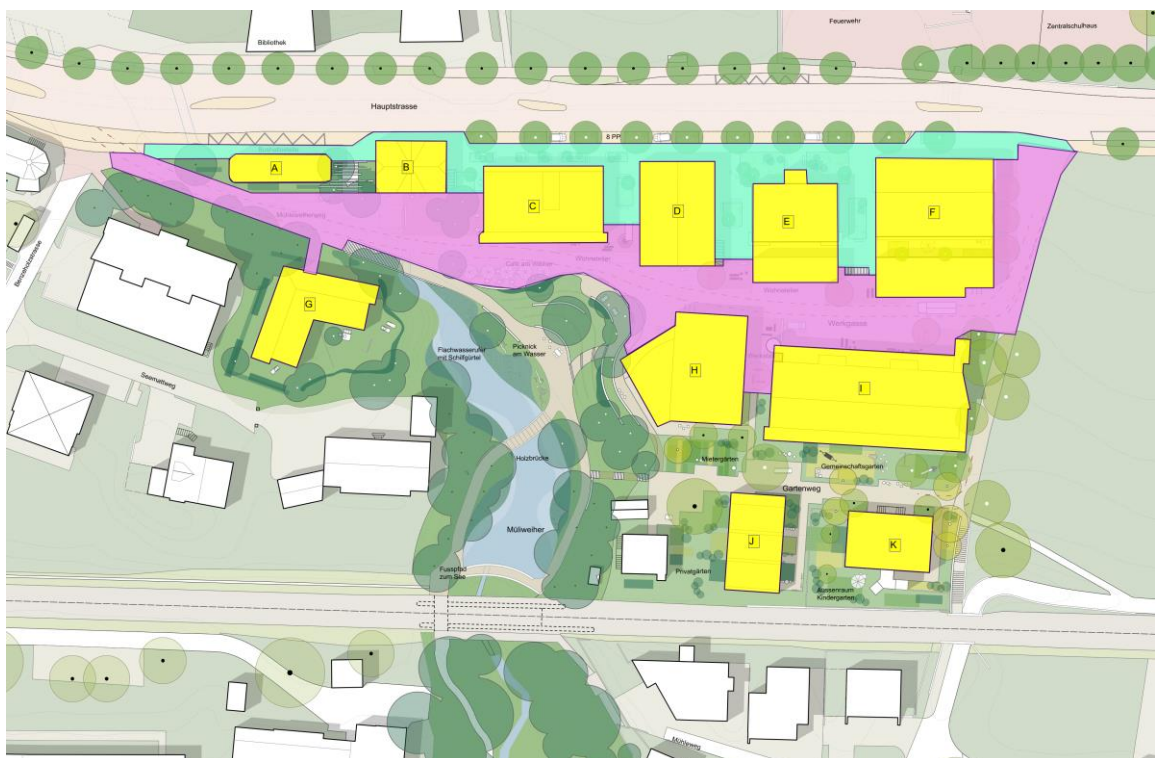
Übersicht befestigte und zu rentendierende Flächen (gelb Dachflächen, türkis Vorplätze zu Hauptstrasse, rosa Strassenfläche) restliche Flächen mit versickerbaren Oberflächen
